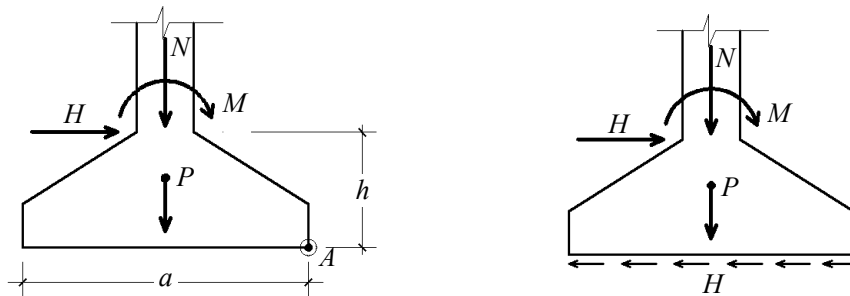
Verificación al vuelco y deslizamiento de la zapata.
